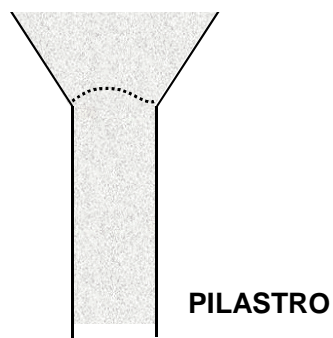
Inarcamento in corrispondenza dell'allargamento di sezione
